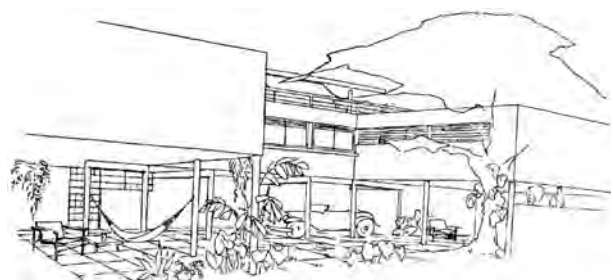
Lucio Costa: *Casas sem dono* [2], primeira metade da década de 30. Perspectiva externa. Lajes planas e vigas aparentes, pórticos isolados com vigas aparentes. [COSTA, 1995]:86
